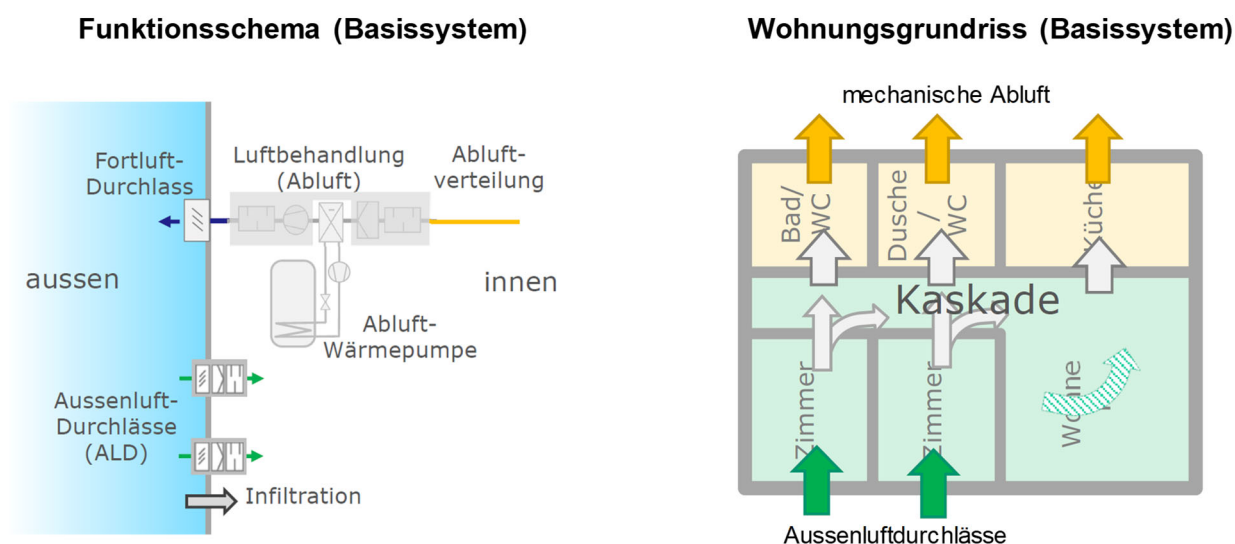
Funktionsschema und Wohnungsgrundriss vom LK4
